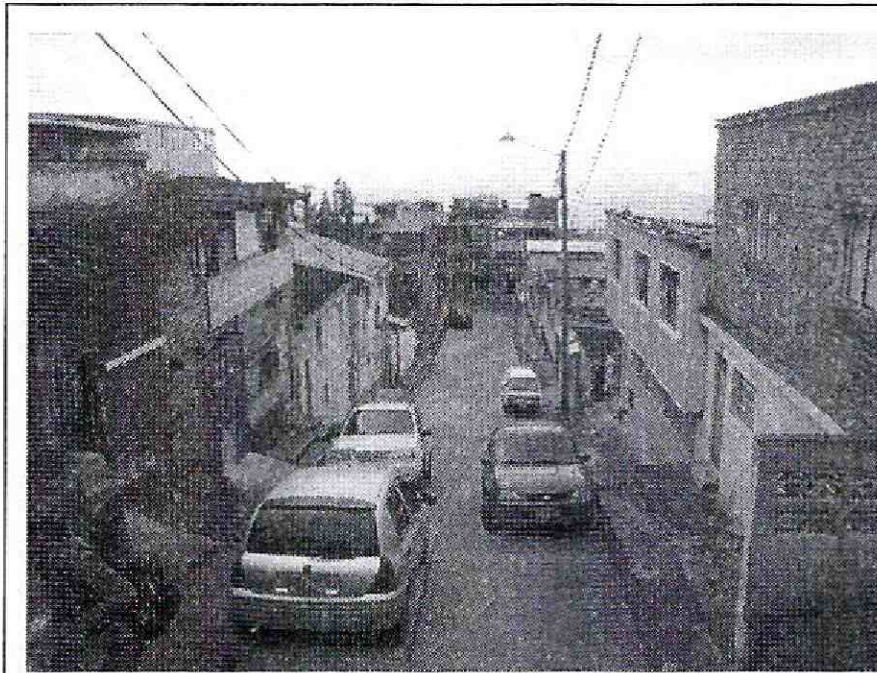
Vista del sector donde se localizará el proyecto de la Calle 36J Sur # 9-84 Este, Localidad de San Cristóbal.
